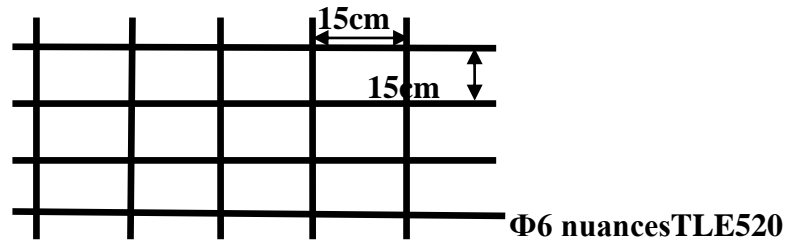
schéma de ferrailage de la dalle de compression
